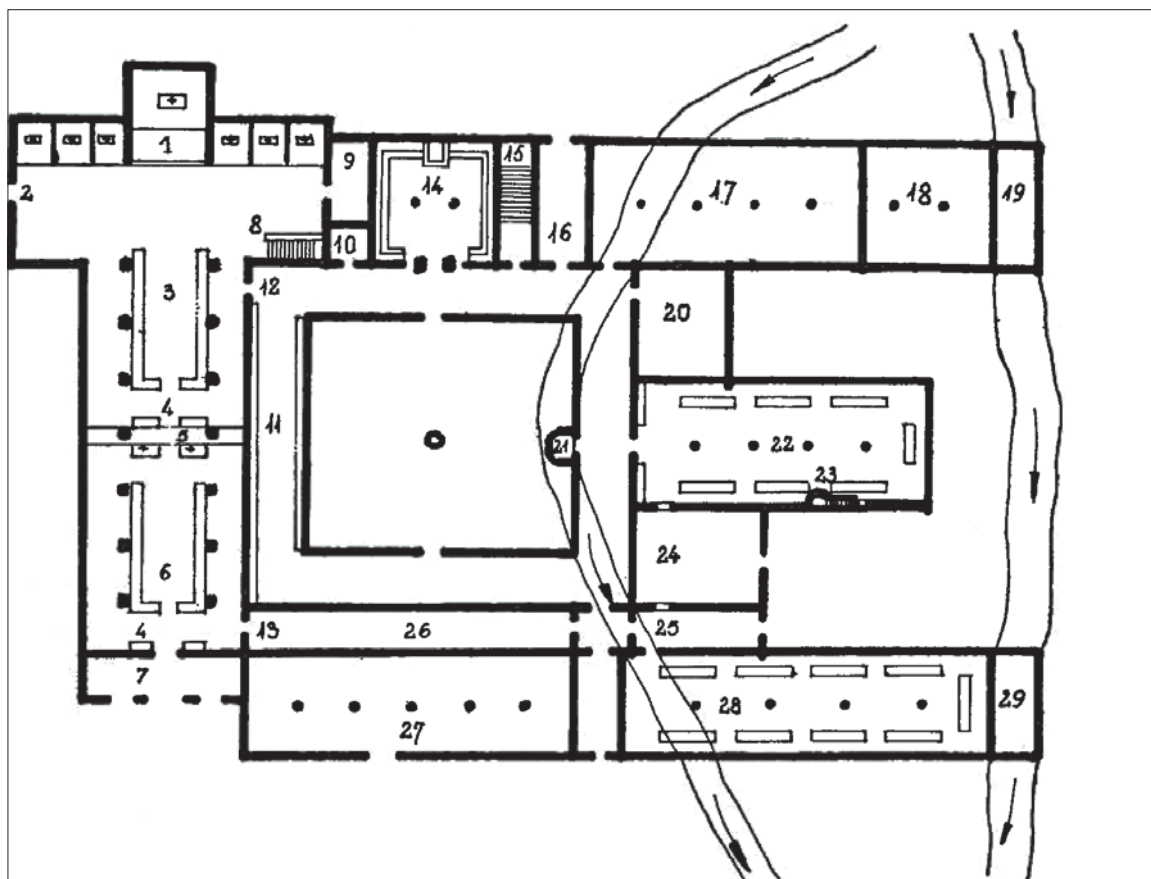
Grundriss des Idealplans eines Zisterzienserklosters
